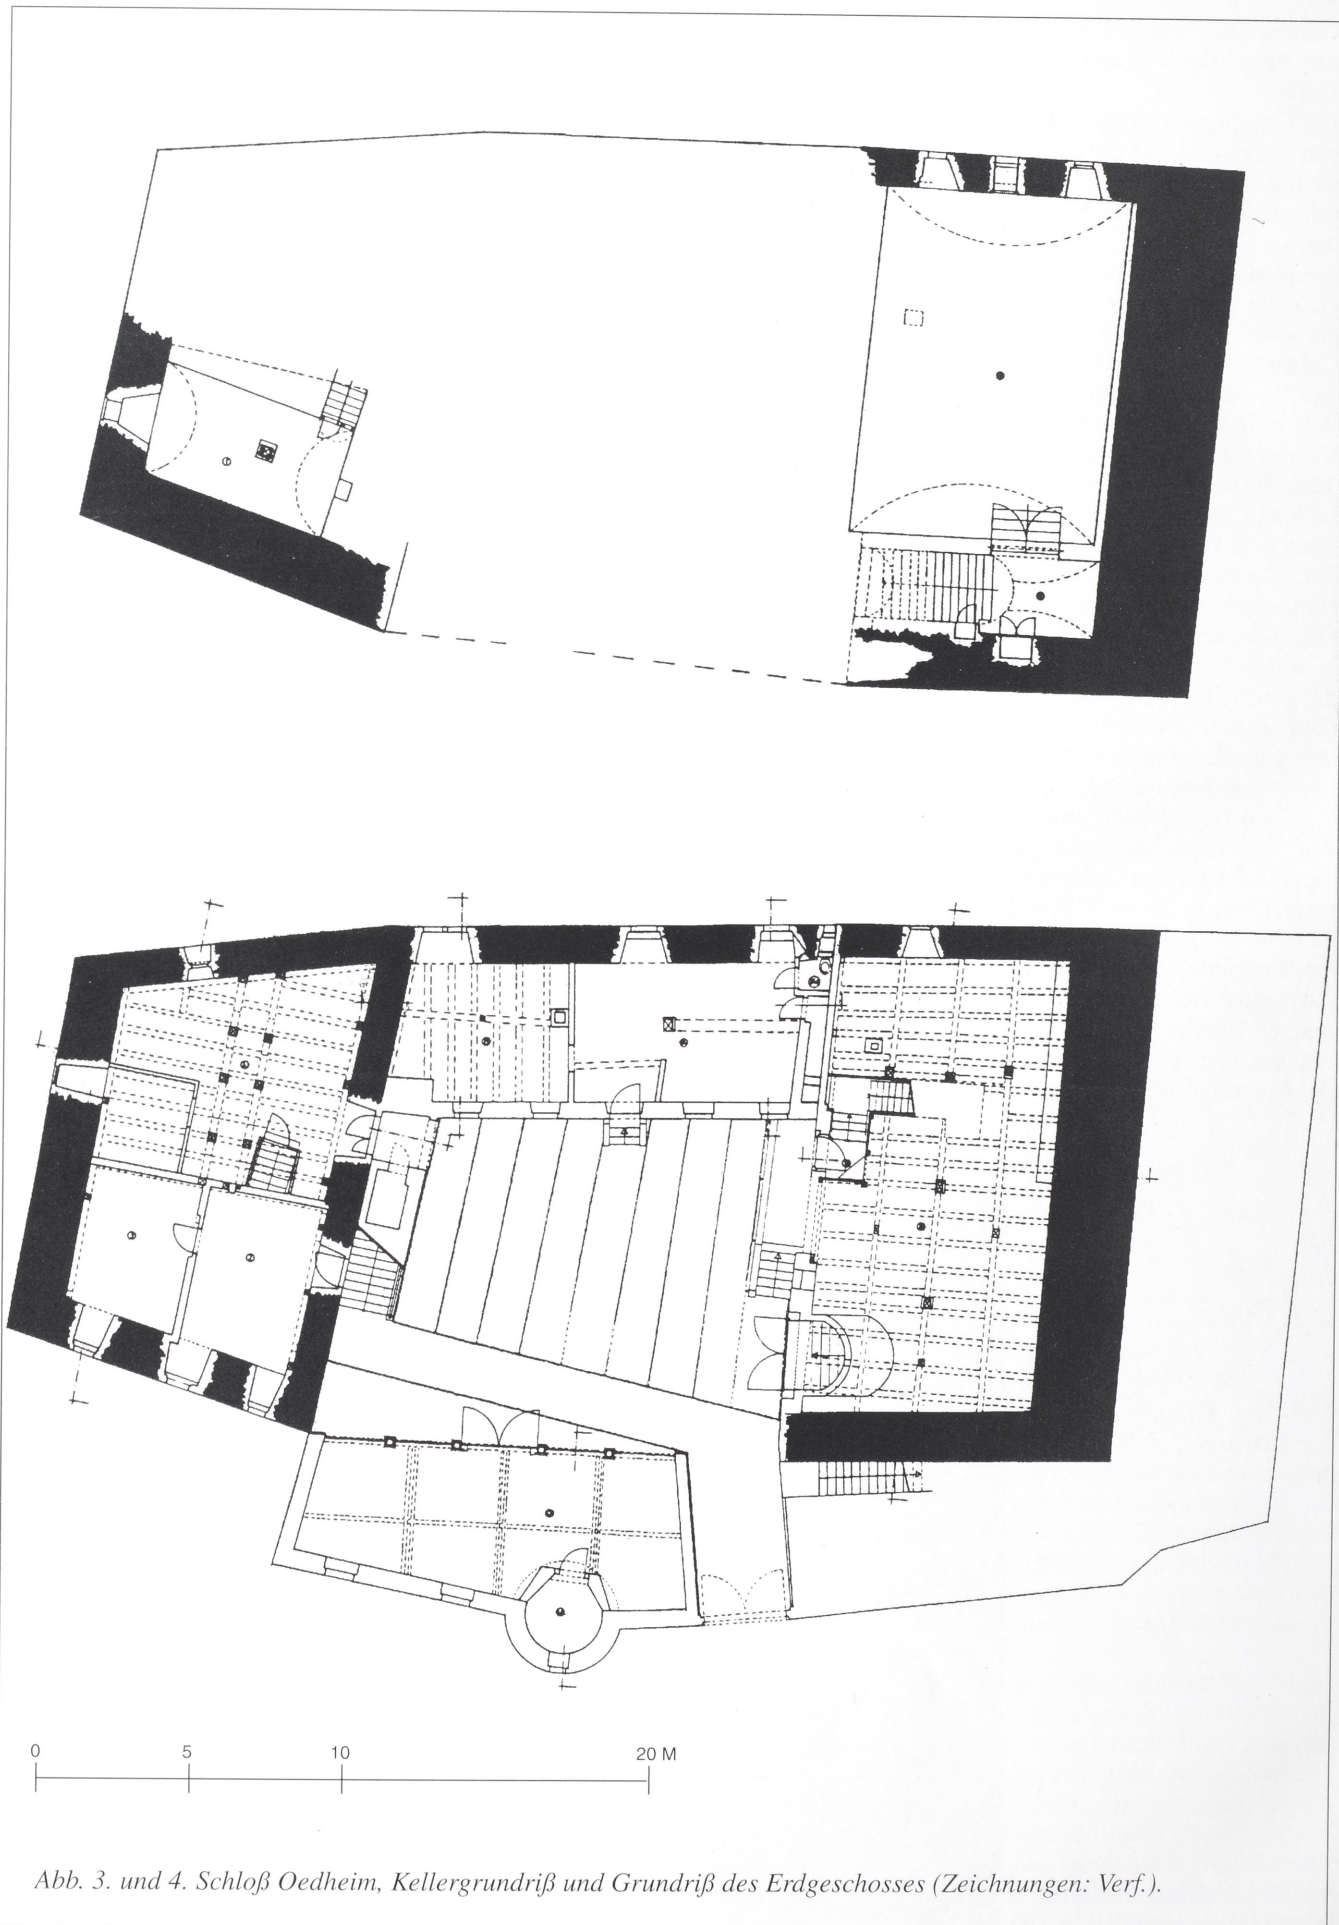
und 4. Schloß Oedheim, Kellergrundriß und Grundriß des Erdgeschosses (Zeichnungen: Verf.).
